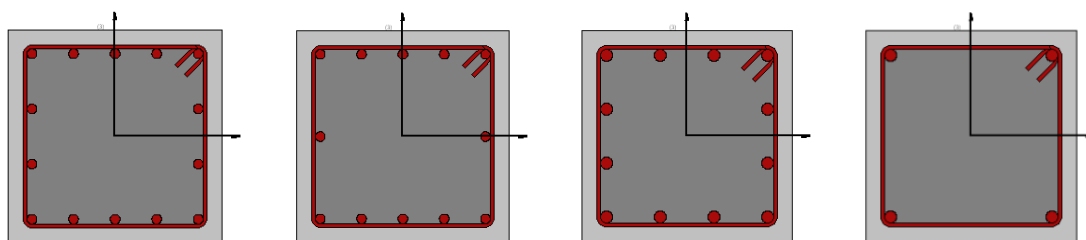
Secções transversais dos pilares P11, P12, P21 e P22, respetivamente
